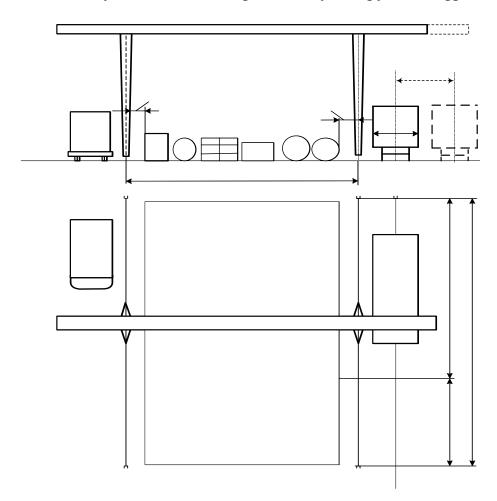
Поперечный разрез и план открытой площадки с козловым краном
